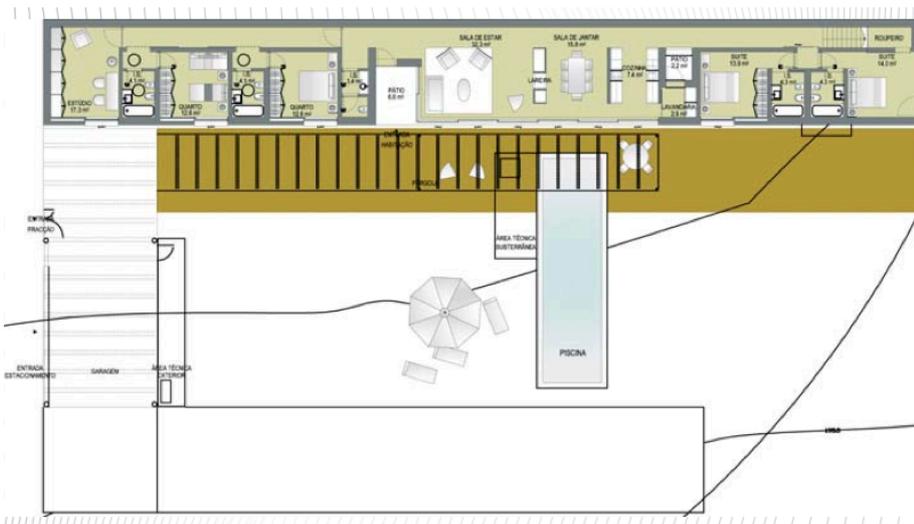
Planta da habitação desenhada por João Luís Carrilho da Graça
